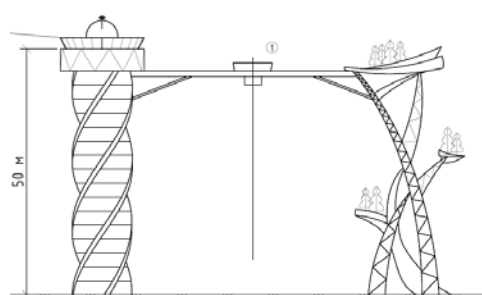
Пара конструкций с открытыми площадками, соединенная жестким мостом:
